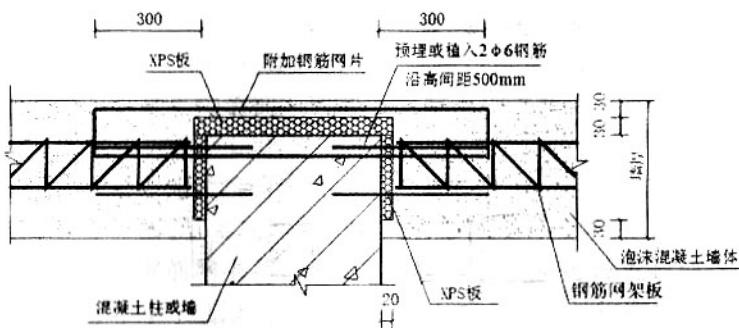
泡沫混凝土墙体与交接处保温构造
